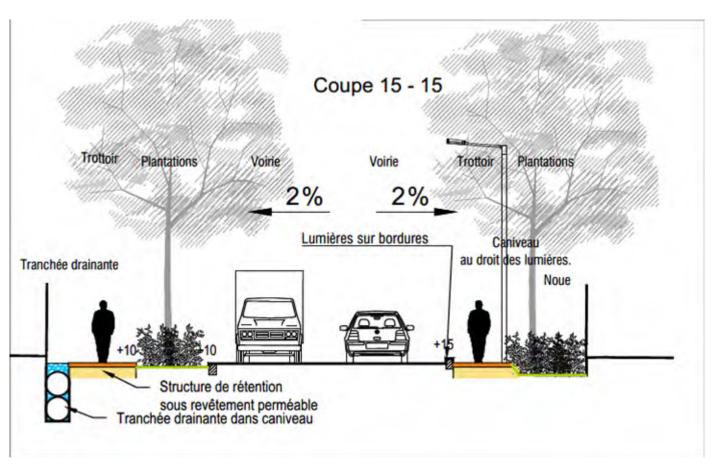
Coupe exemple (rue du Dirigeable) de modification de caniveaux béton en tranchée drainante
